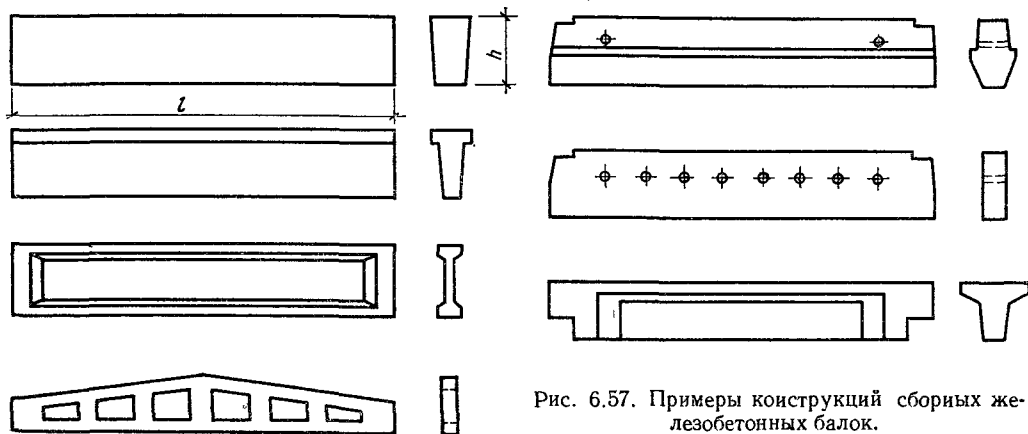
Примеры конструкций сборных железобетонных балок.
